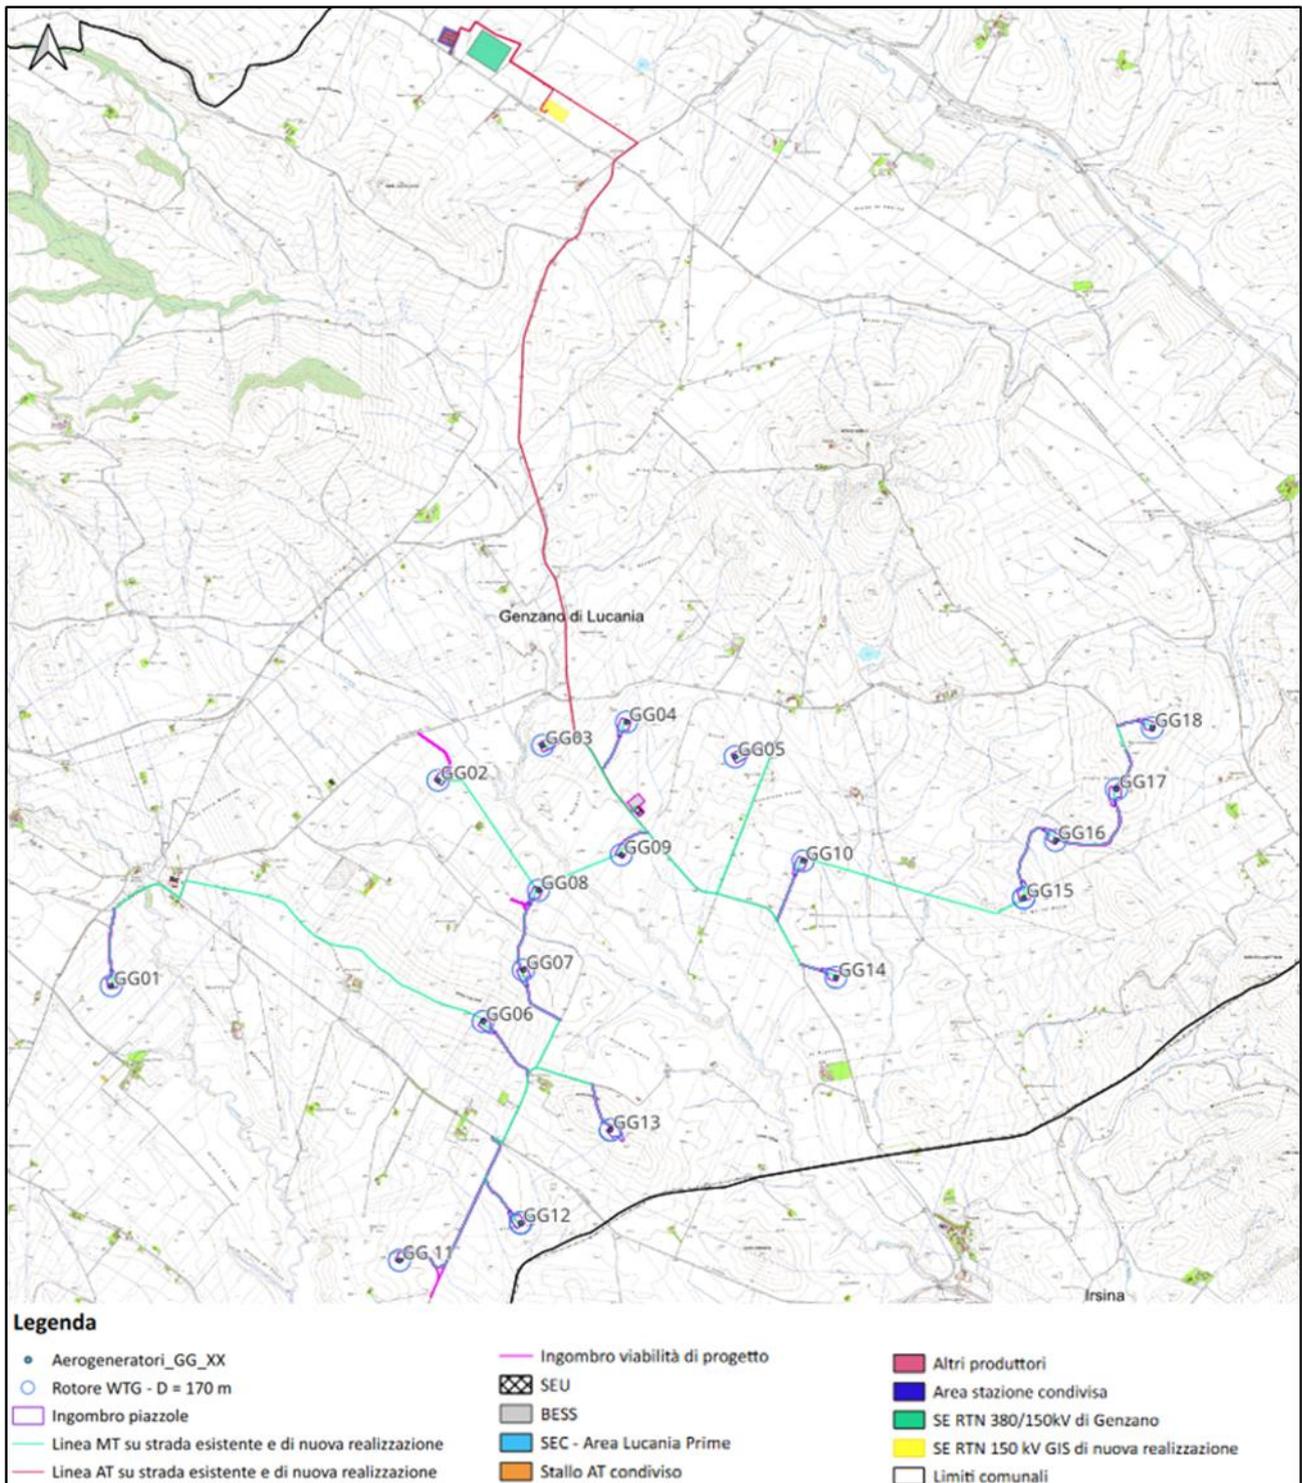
Layout d'impianto con viabilità di progetto su CTR
